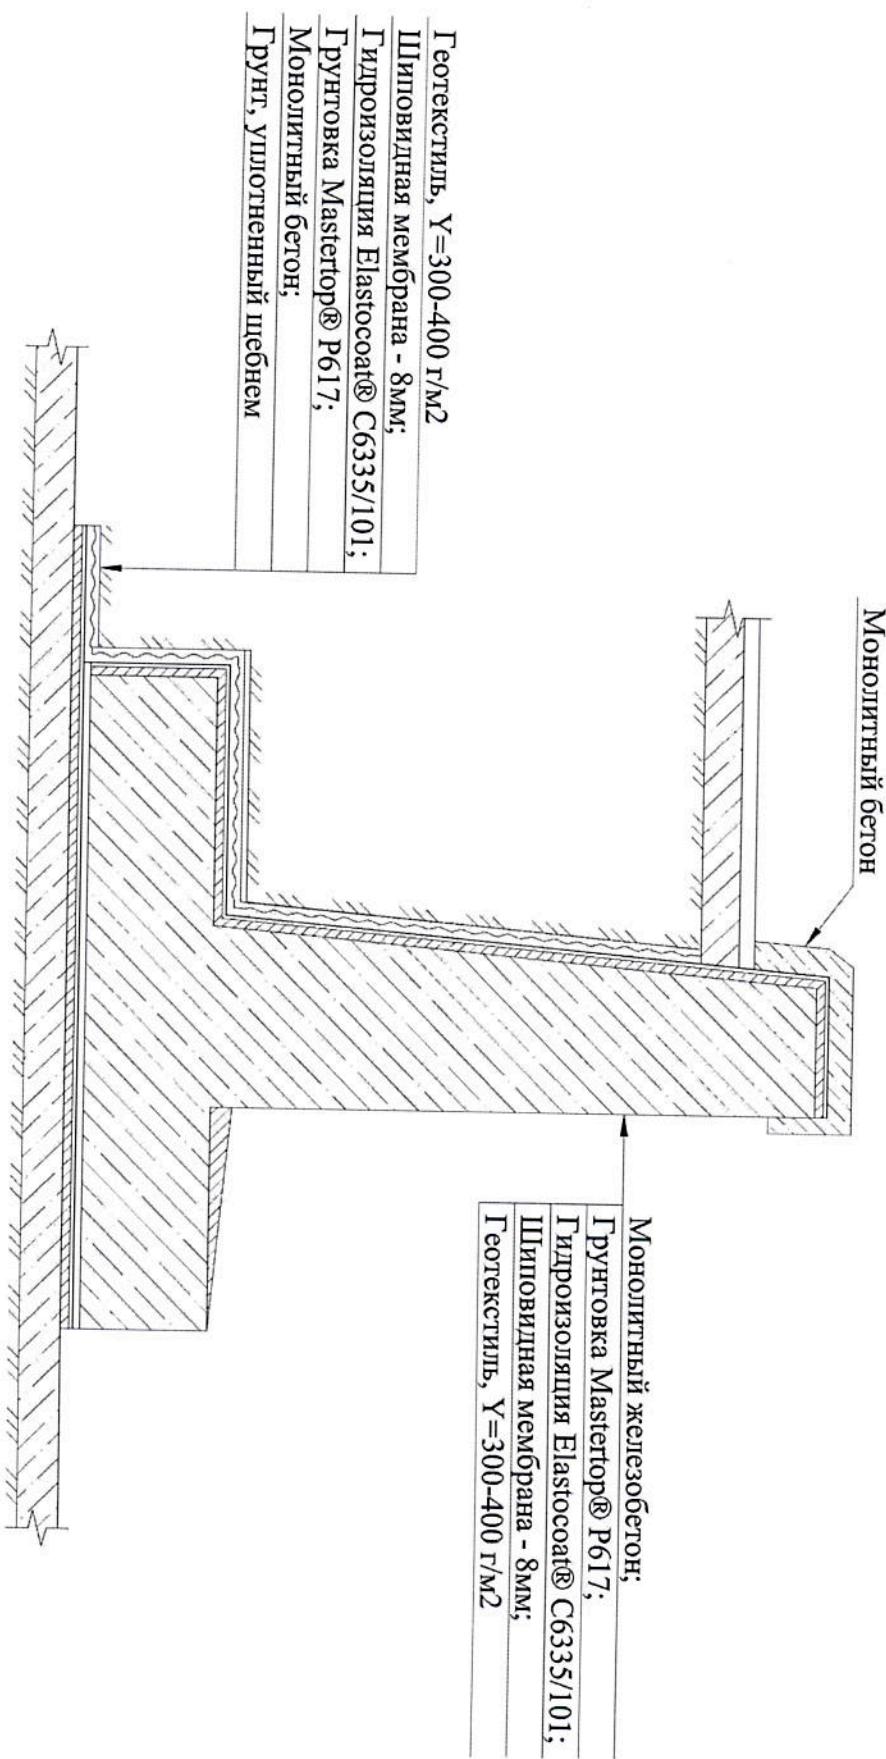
Конструктивное решение гидроизоляции монолитных железобетонных подпорных стен
